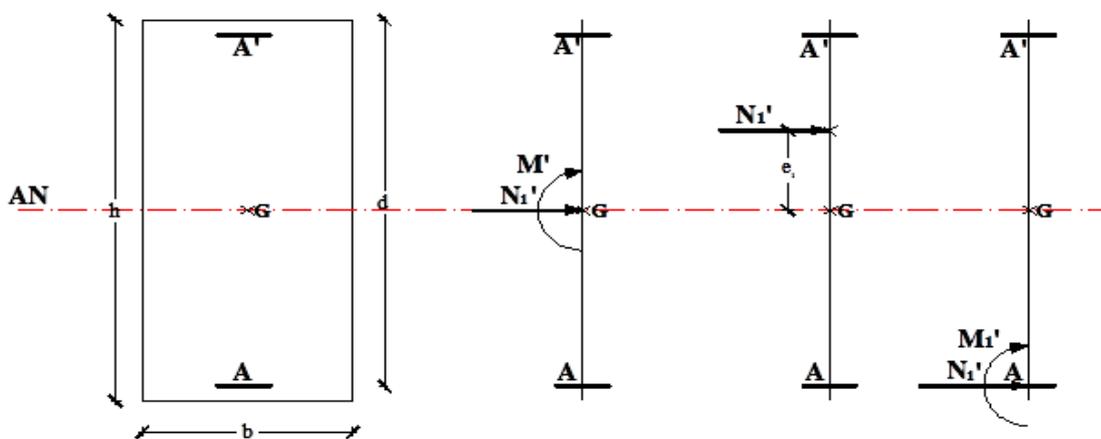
Position de N_1' , M_1' et M_1 sur la section transversale
